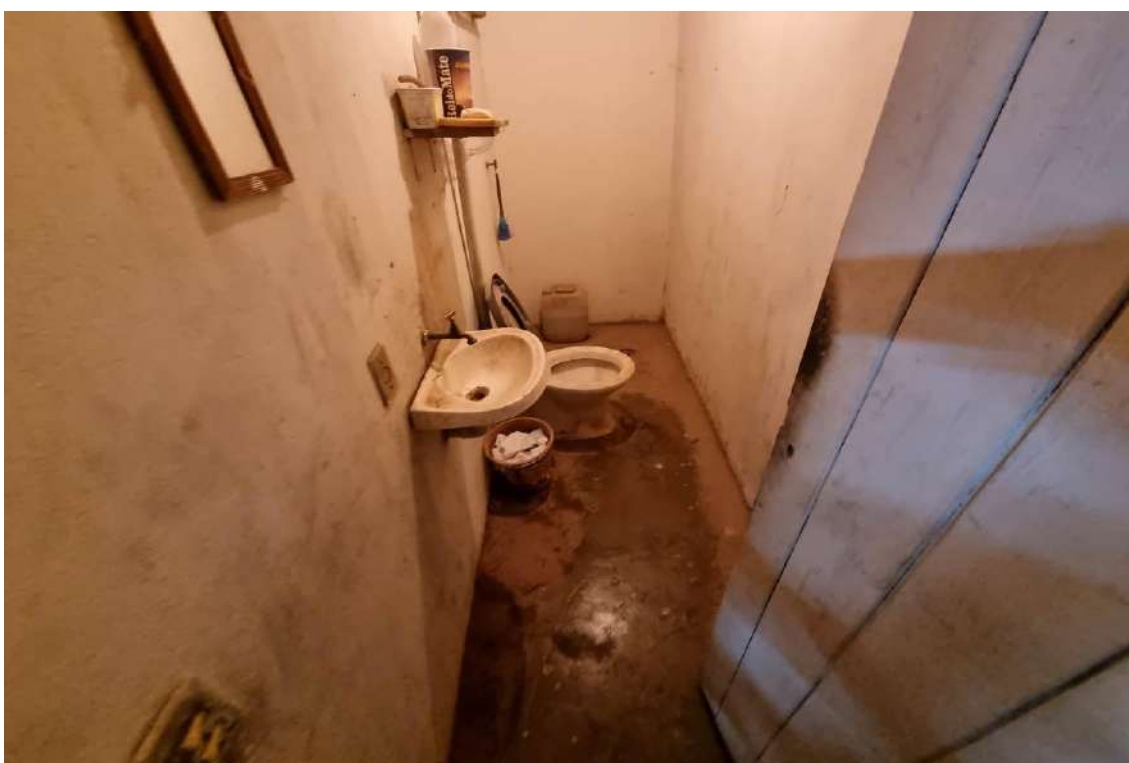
Vista do banheiro do imóvel nº 168. Apresentando padrões construtivos de piso cimentado, alvenarias revestidas em pintura látex PVA sobre massa, forro de madeira e portas de madeira.
